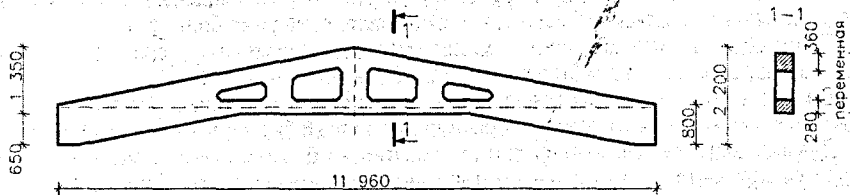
Стропильная балка каркаса бессварочного монтажа
